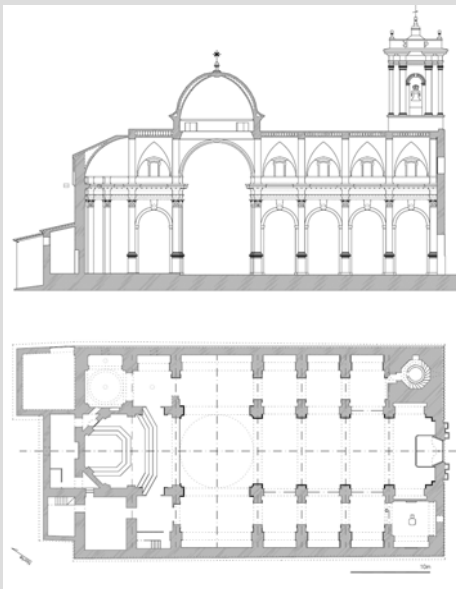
Planta y sección estado actual Villahermosa del Río (Pitarch&Sáez)
